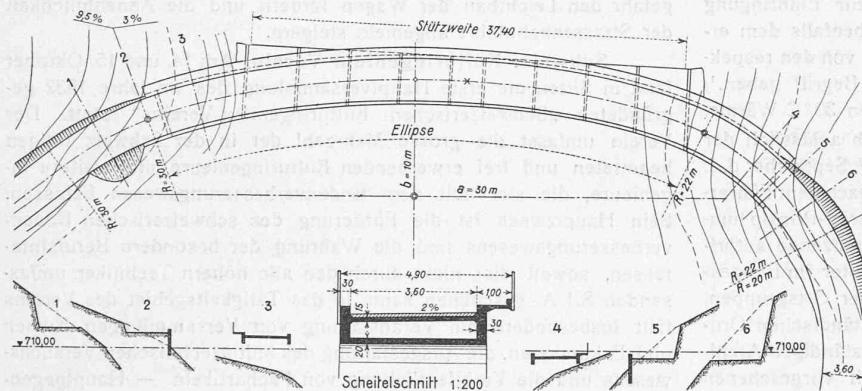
Grundriss (mit 2 m-Kurven) und Querprofile 1 : 600, Scheitelschnitt 1 : 200 der Schwandbachbrücke bei Schwarzenburg, Kt. Bern. — Entwurf Ing. R. Maillart.
